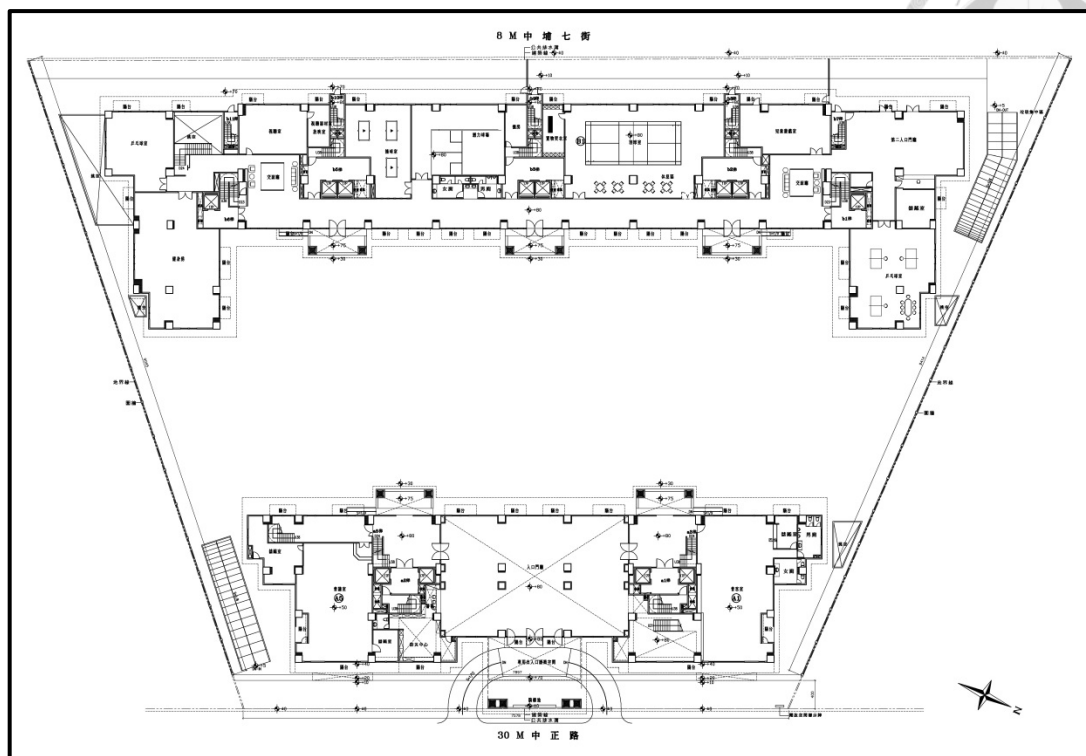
○○藝術廣場社區集合住宅平面配置圖
